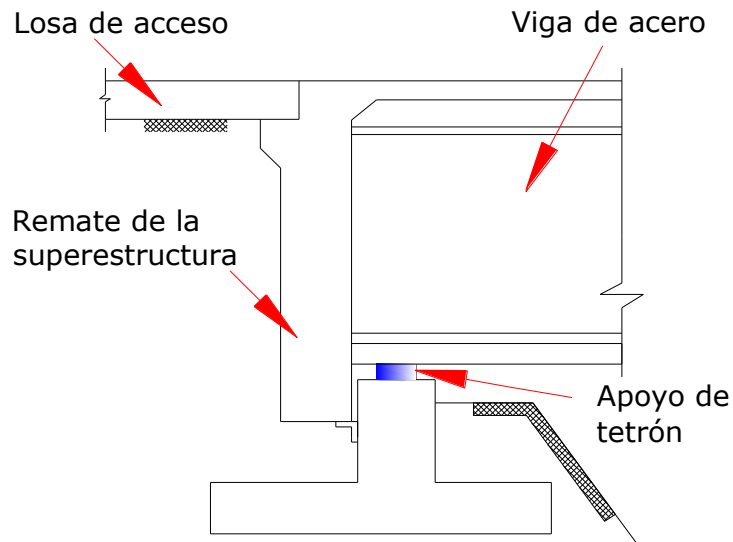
Estribo semi-integral, tipo encapsulado de tetrón, con viga de acero
